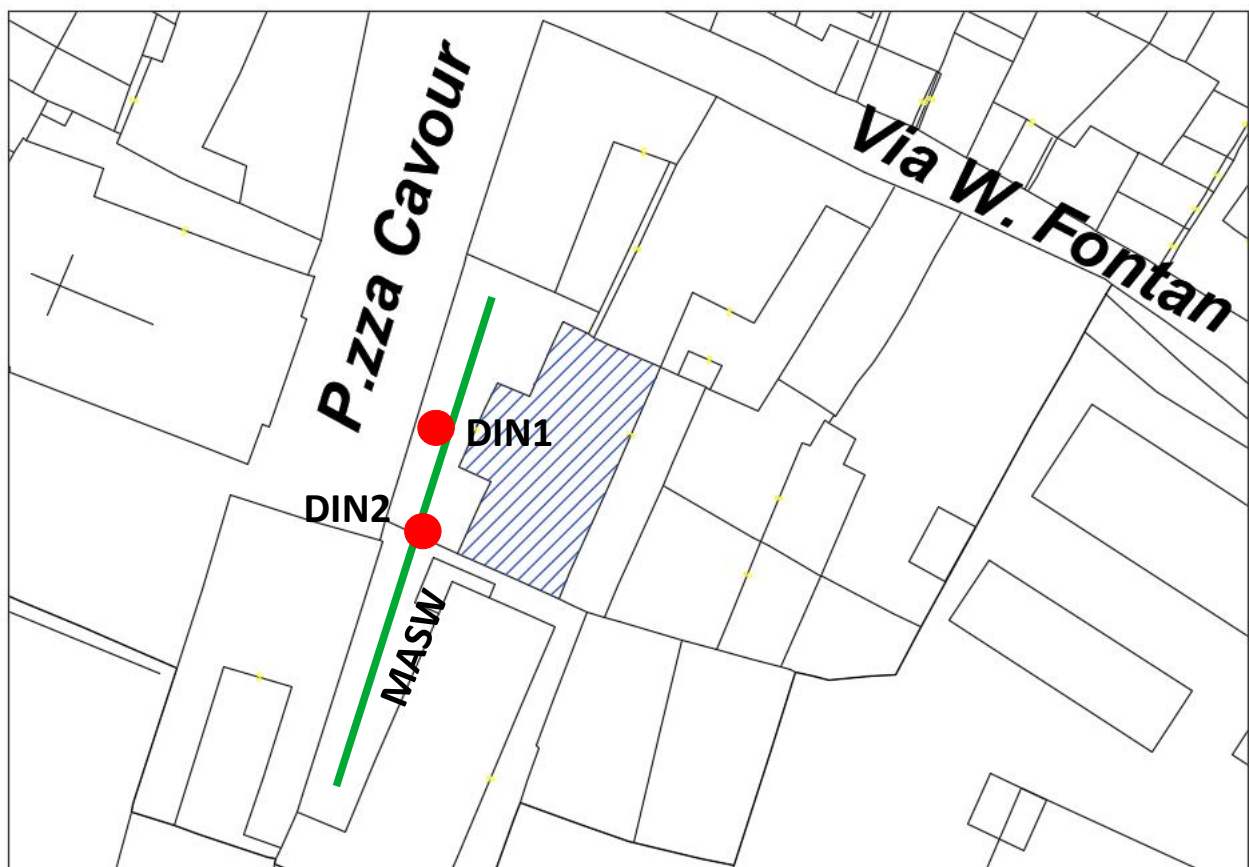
stralcio planimetrico con ubicazione delle indagini eseguite
